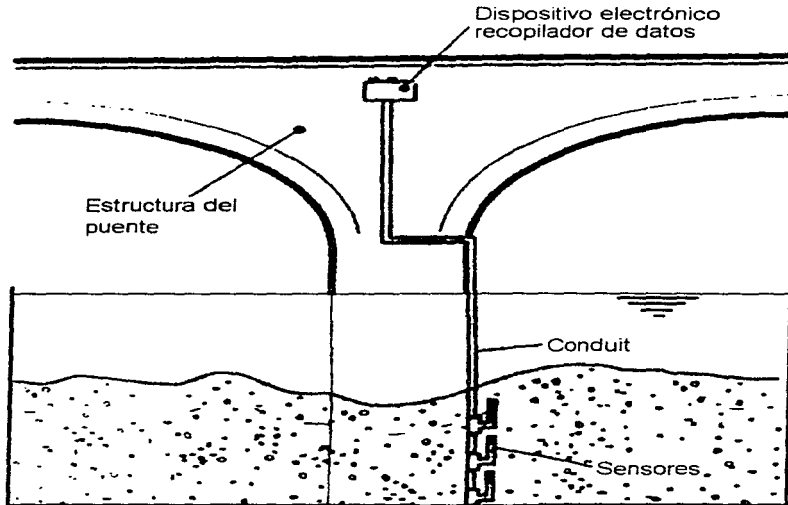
Arreglo típico del sistema Wallingford, según HR Wallingford.
